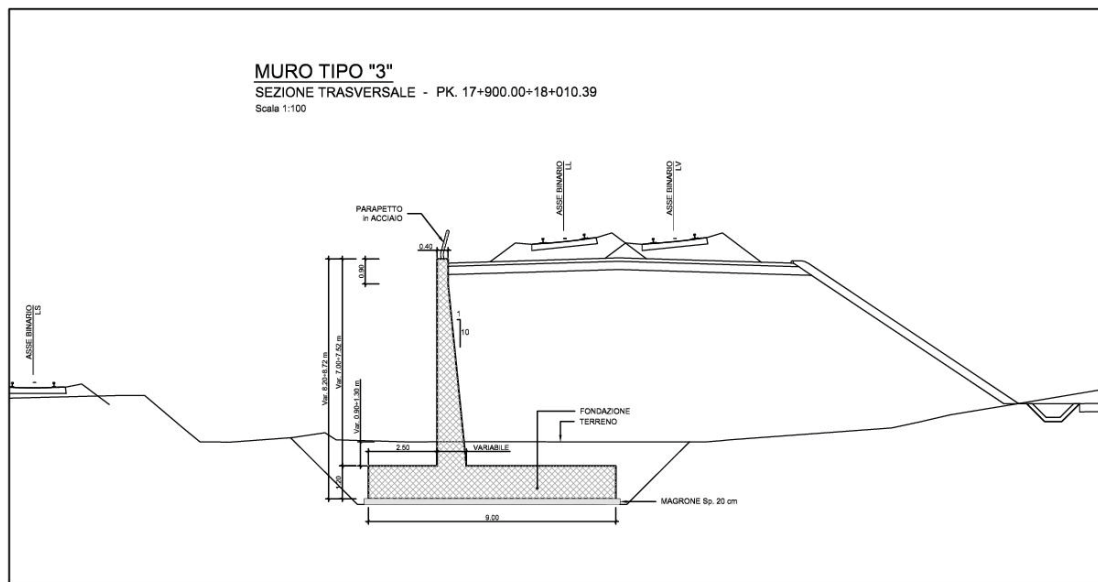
RI05: Muro di sostegno in sx MU03 – Sezione trasversale muro tipo 3.
